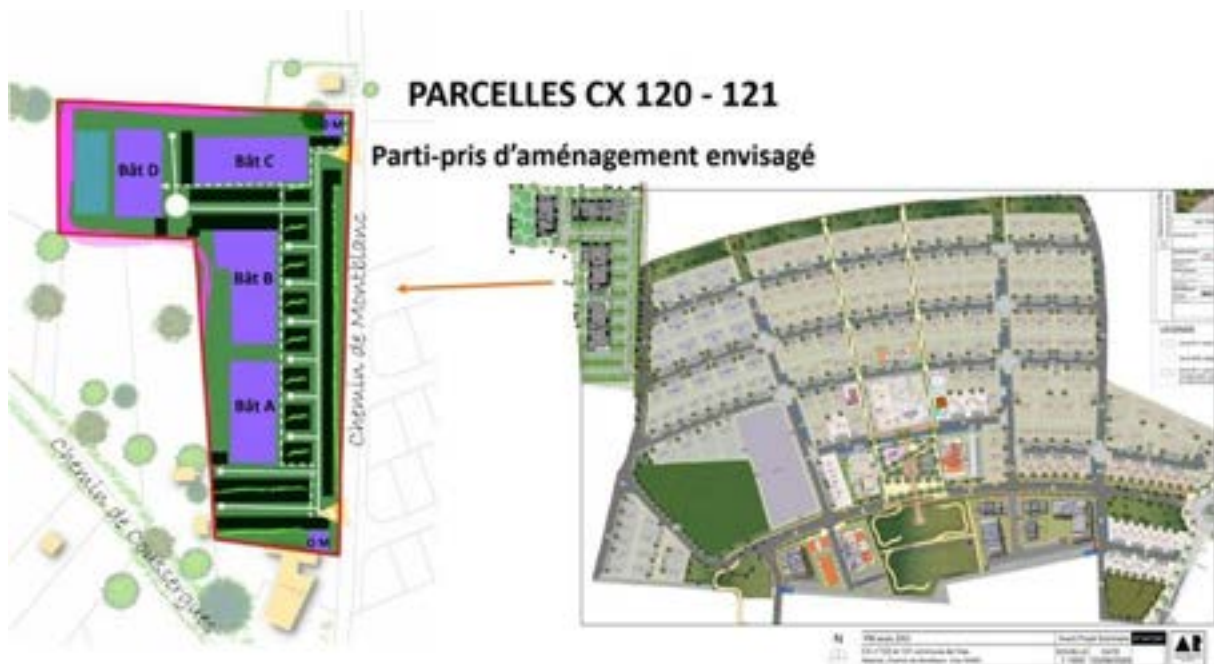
Plan de masse du projet (Source : ArchiGroup)
